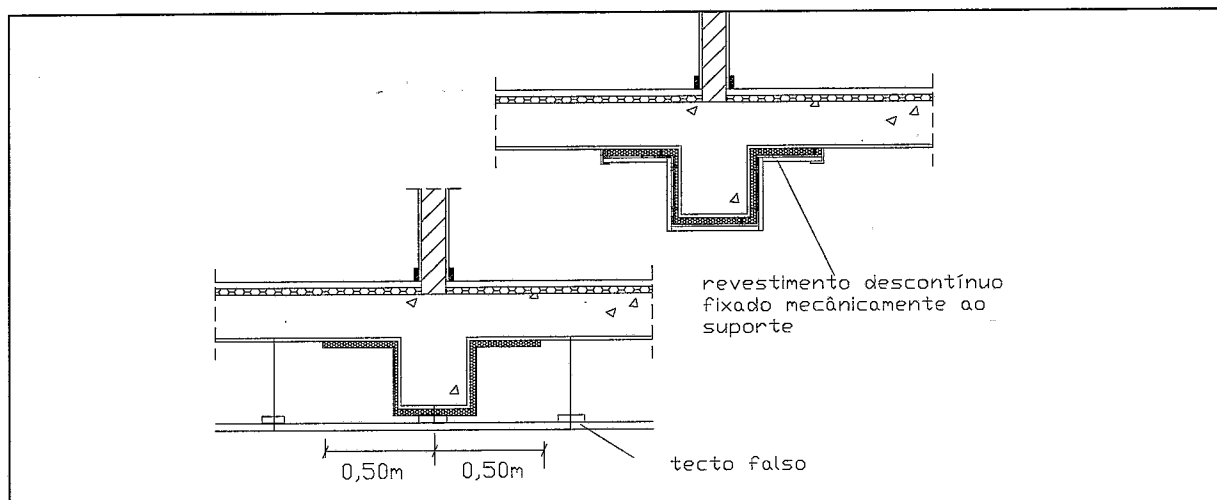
Pormenor da correcção térmica pelo exterior com aplicação de isolante térmico sob laje e protecção com tecto falso ou revestimento descontínuo e independente
